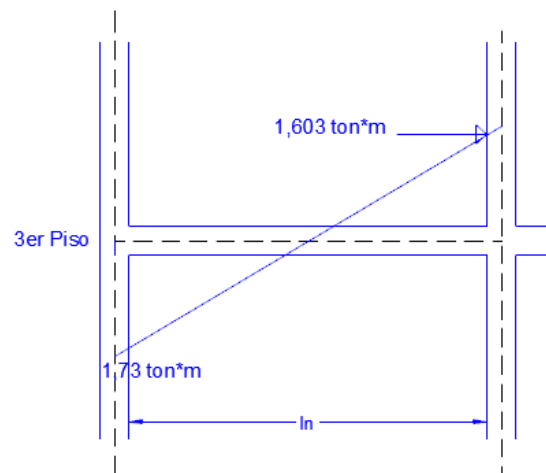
20 Momentos en los extremos de las vigas eje Y del sistema aporticado con muros de corte.
